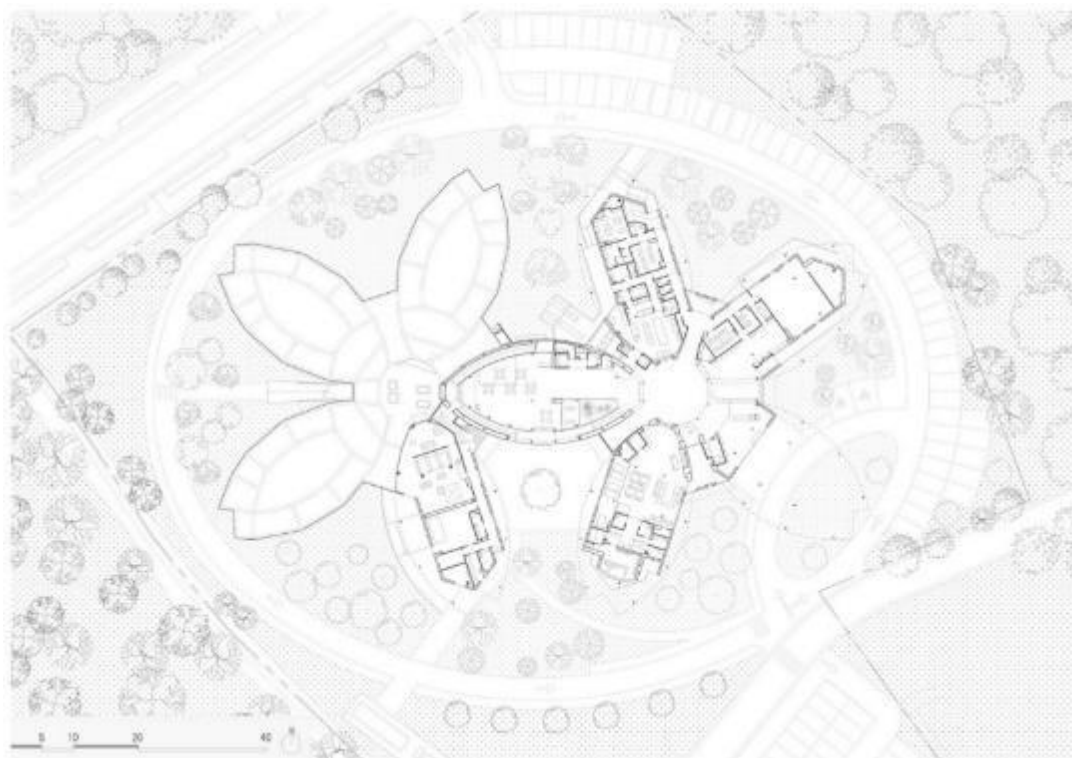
План 1 поверху будівлі «Sakuragi»
